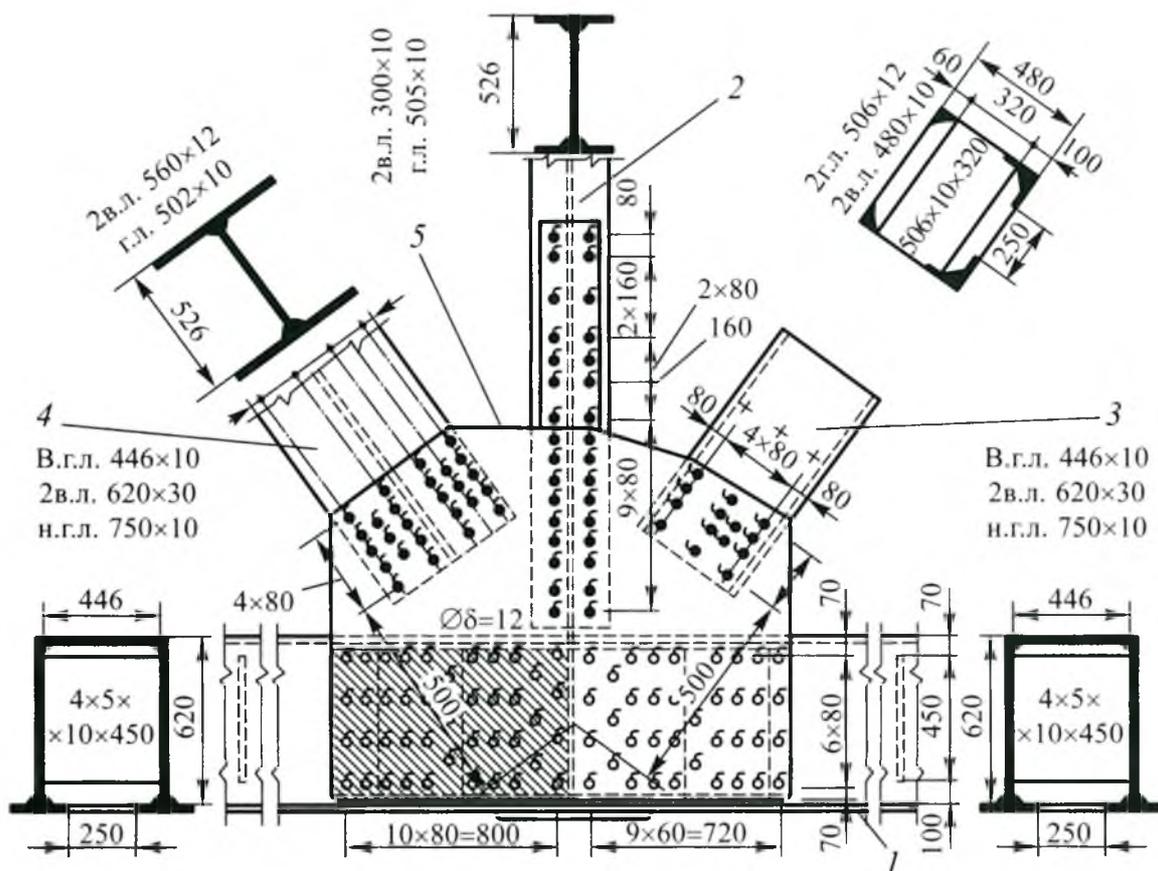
Конструкция узла ферм на высокопрочных болтах:
